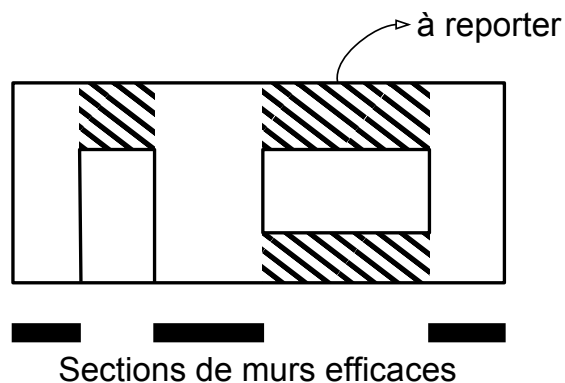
Différences entre les lignes d'appuis et les murs structuraux. La ligne d'appui du plancher fait toute la longueur du mur. Par contre, les murs structuraux qui supportent effectivement les charges ont une section réduite par rapport à la section totale du mur, à cause de la présence des ouvertures. Le poids des baies situées au-dessus et en-dessous des ouvertures devra être reporté sur les murs adjacents.
